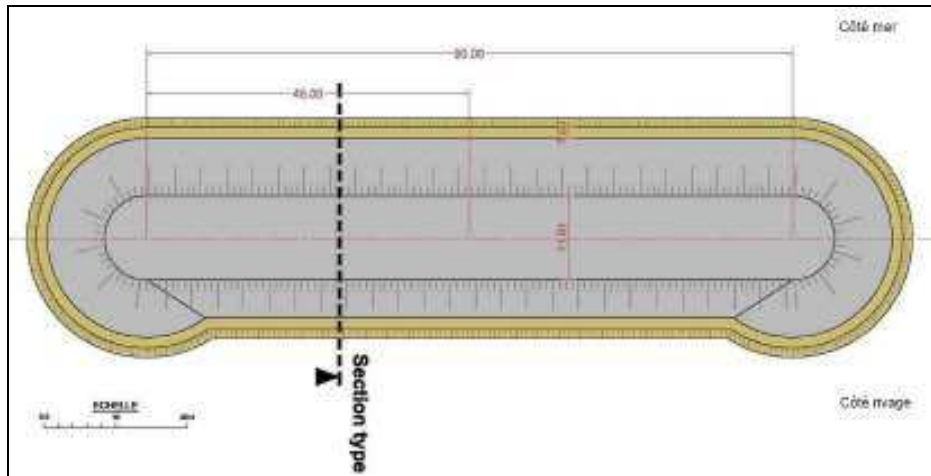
Vue en plan des brise-lames hauts de la variante n°2 de protection de Palm Beach.
